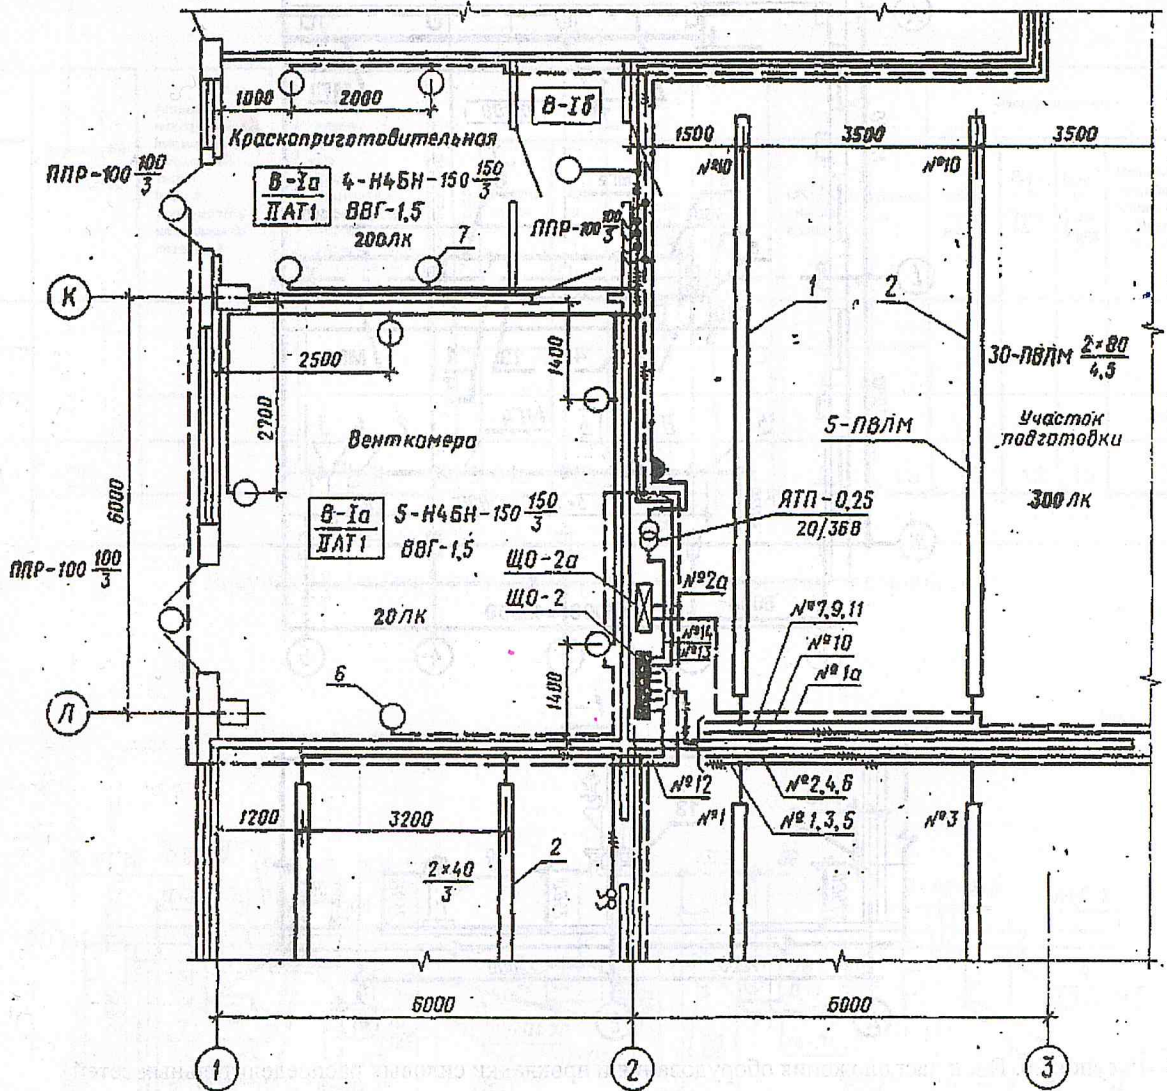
План расположения и прокладки электрических осветительных сетей для производственного здания
